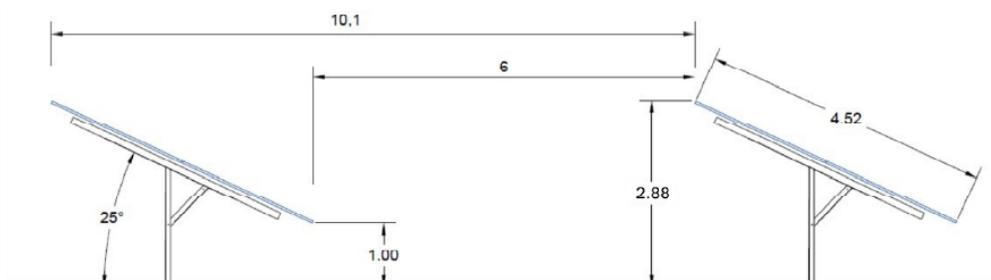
Vue en coupe des tables d'assemblage, dimensions en mètre (Source : Sogsolar)
